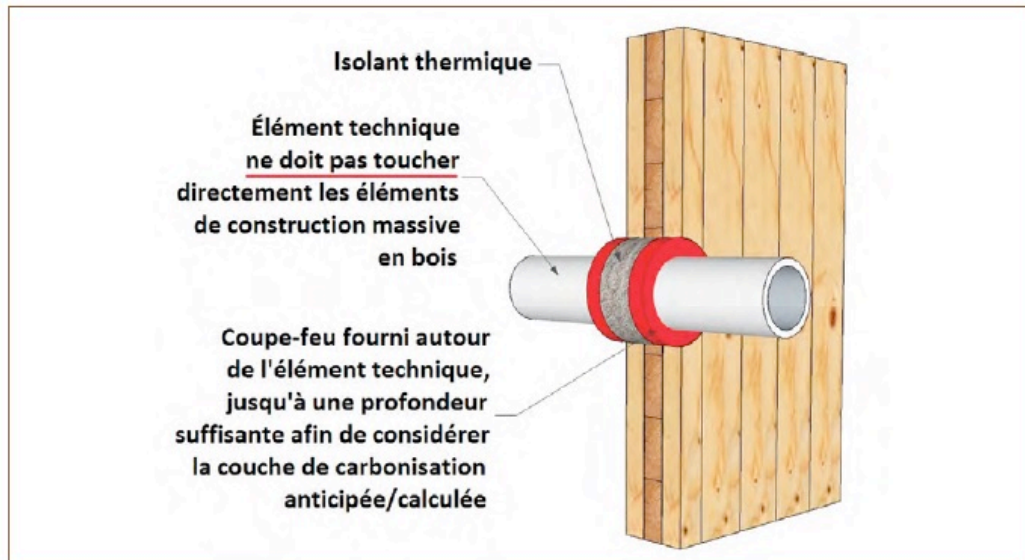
Protection d'une traversée de paroi verticale (Source : Bâtiments de construction massive en bois d'au plus 12 étages – Directives et guide explicatif – Gouvernement du Québec – 2015)
